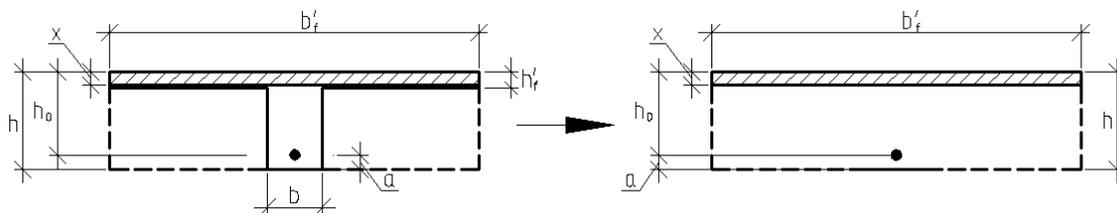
1 случай положения границы сжатой зоны бетона в элементах таврового профиля
